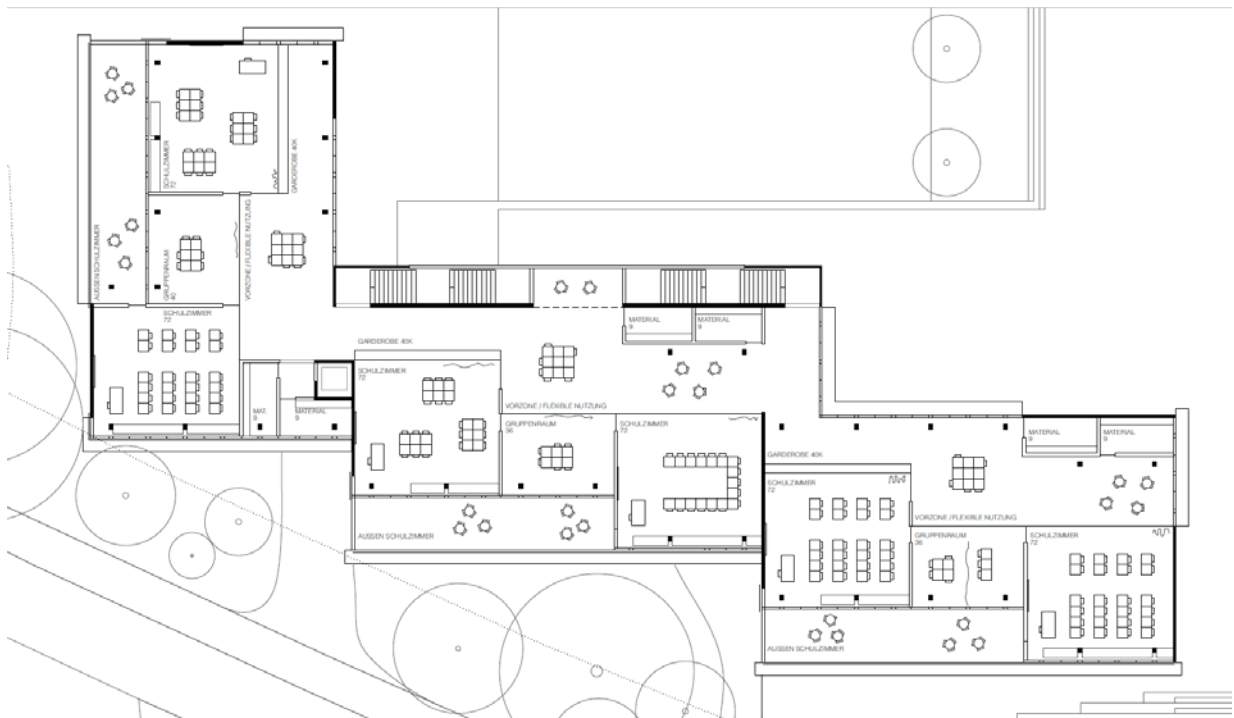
Grundriss Obergeschoss des Siegerprojekts BILL
